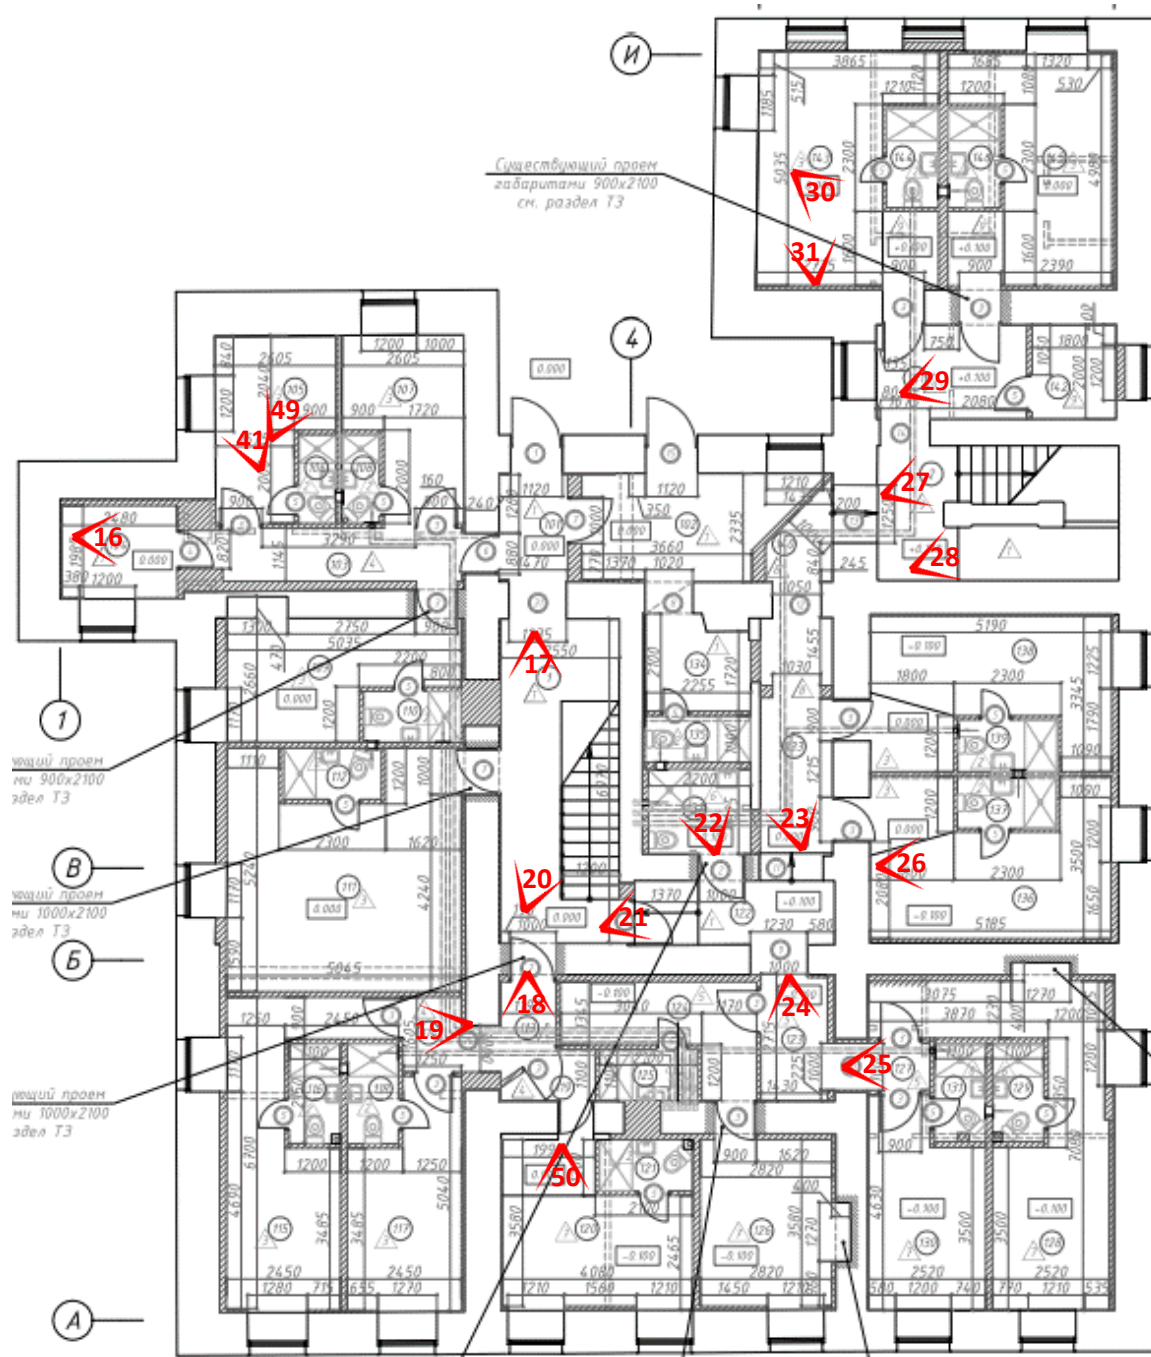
Схема фотофиксации на плане помещений, 1 этаж
